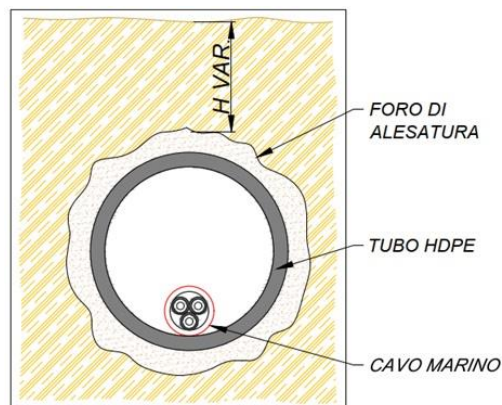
Schematico di installazione del cavo all'interno del tubo HDPE
